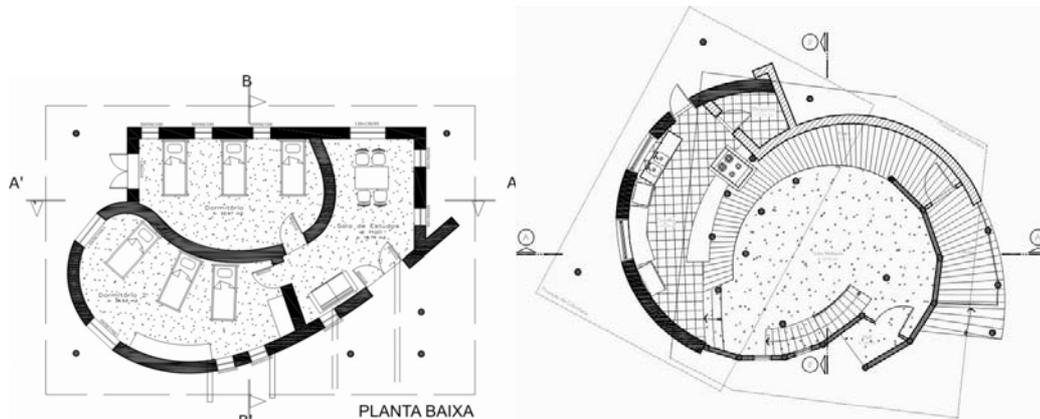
Planta Baixa Alojamento Feminino e Casa Mãe – IMCA
